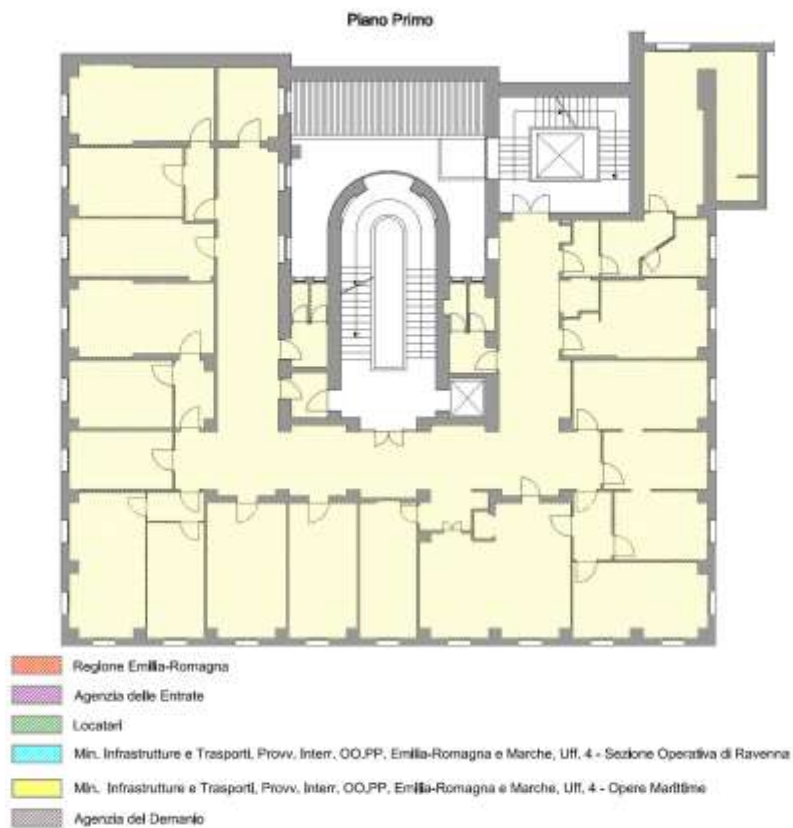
Pianta degli spazi occupati: piano primo.
